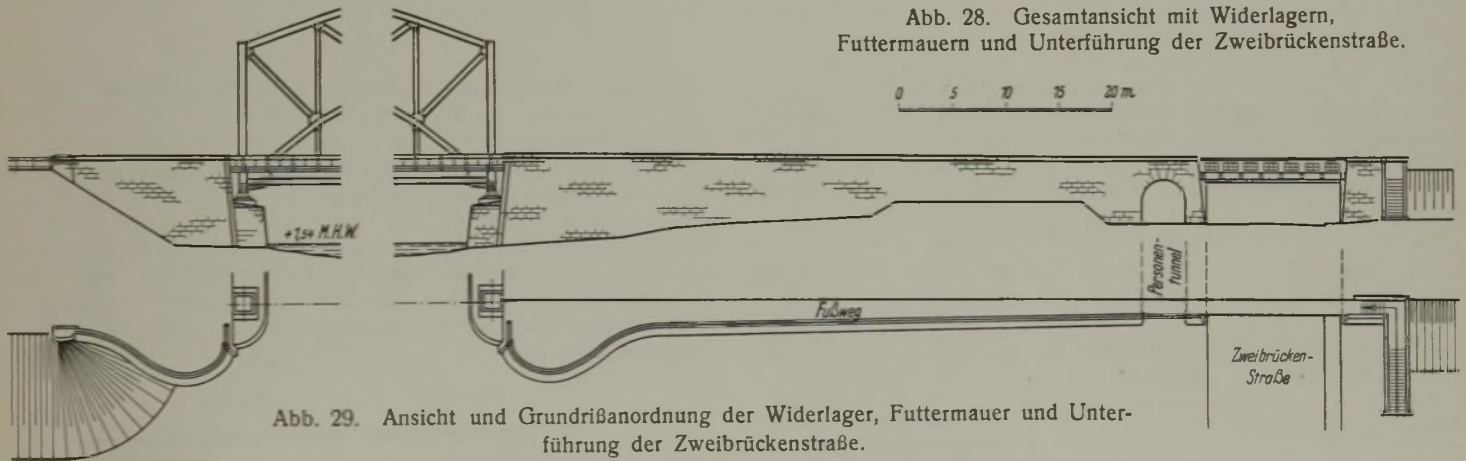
Ansicht und Grundrißanordnung der Widerlager, Futtermauer und Unterführung der Zweibrückenstraße.
